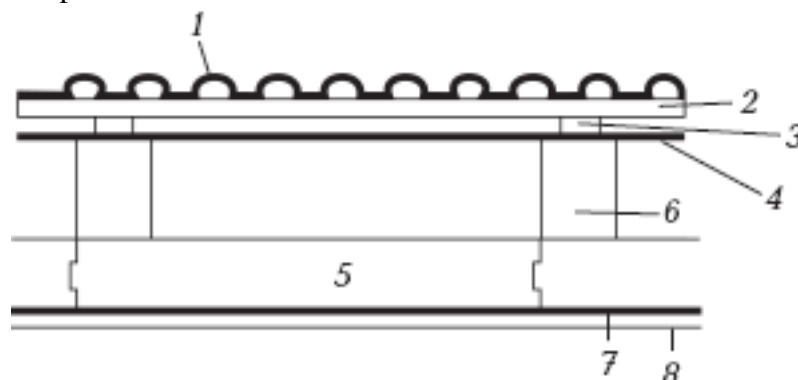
Утепление крыши с укладкой теплоизоляционного материала под стропилами: 1 – кровельное покрытие; 2 – обрешетка; 3 – брусок; 4 – ветро-, влагозащитная мембрана; 5 – утеплитель; 6 – стропила; 7 – гидроизоляция; 8 – обрешетка
